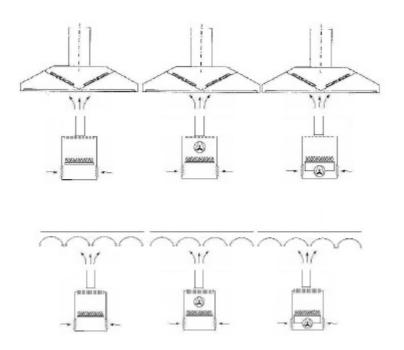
Installazione di apparecchi di tipo A1/ A2/ A3, con condotto singolo, sotto un sistema di aspirazione con ventilazione naturale
